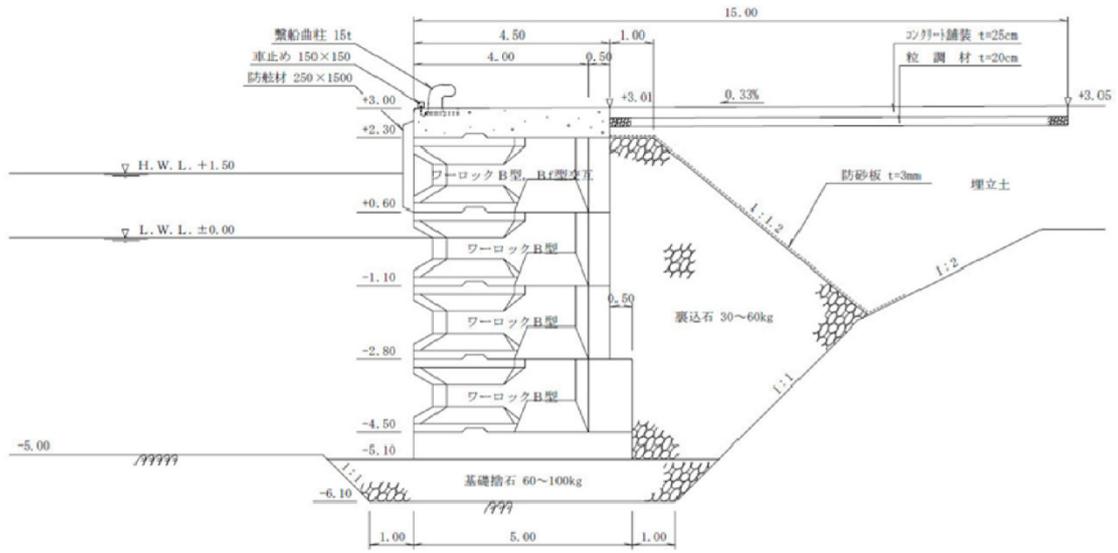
No.8 日立港区_第3ふ頭地区 A 岸壁の標準断面図
